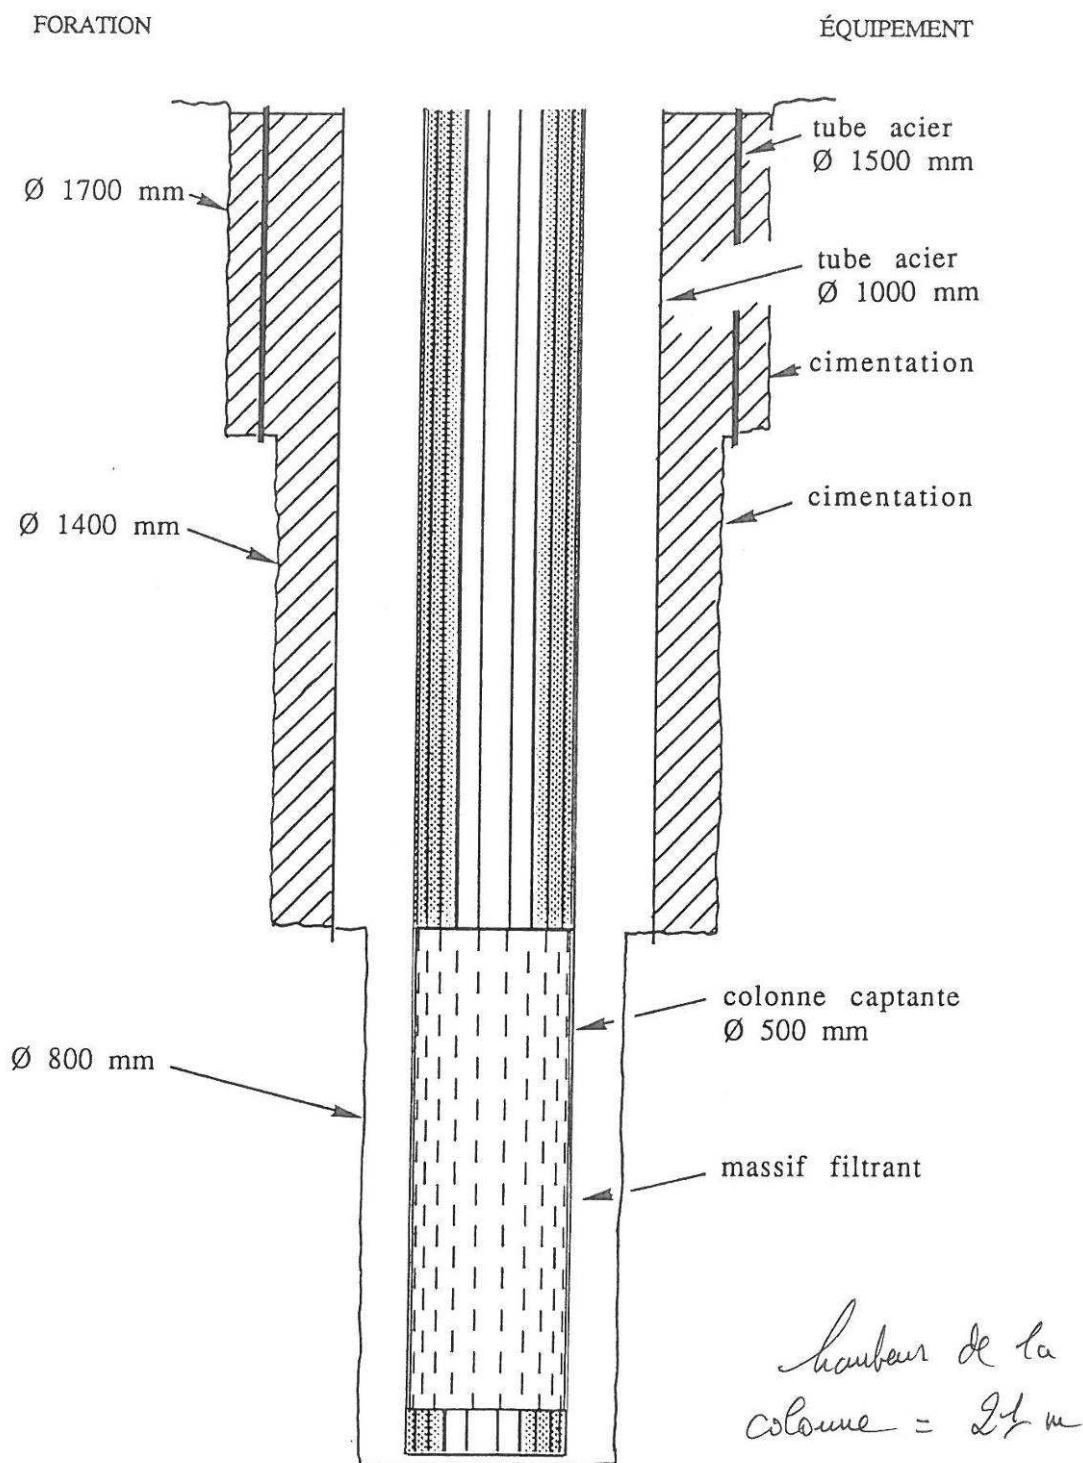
Coupe technique du forage exploité à Camaret-sur-Aigues (84)
